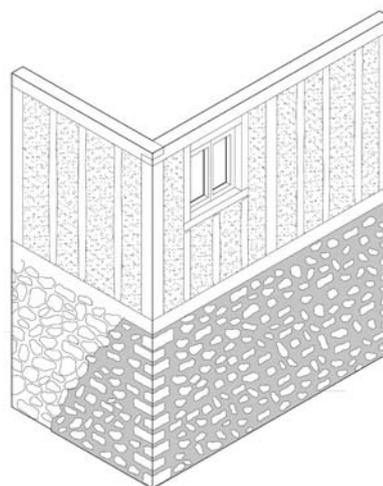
Rejuntado con cemento de la planta baja de piedra de un edificio de entramado.
